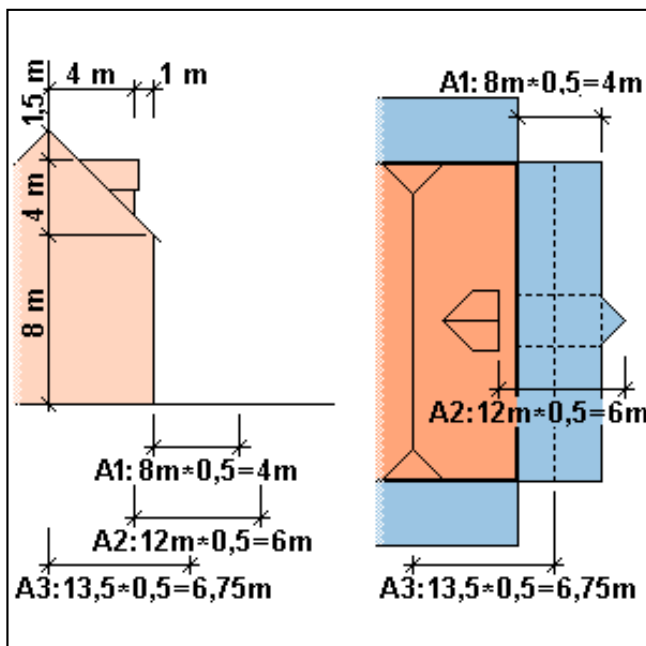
Maksymalne głębokości uprzywilejowanych podporządkowanych elementów konstrukcyjnych lub występów konstrukcyjnych budynku
